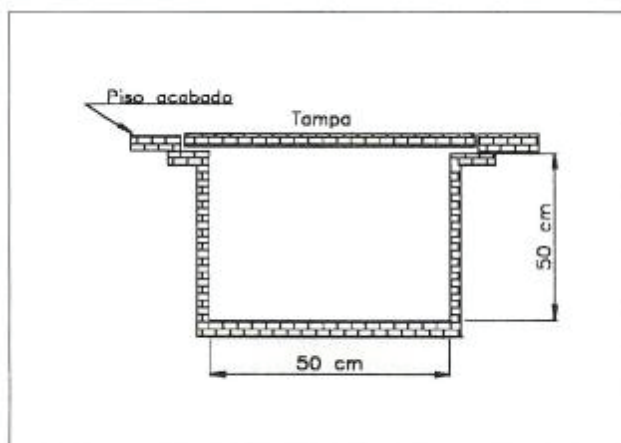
Corte transversal de canaleta construída em alvenaria
